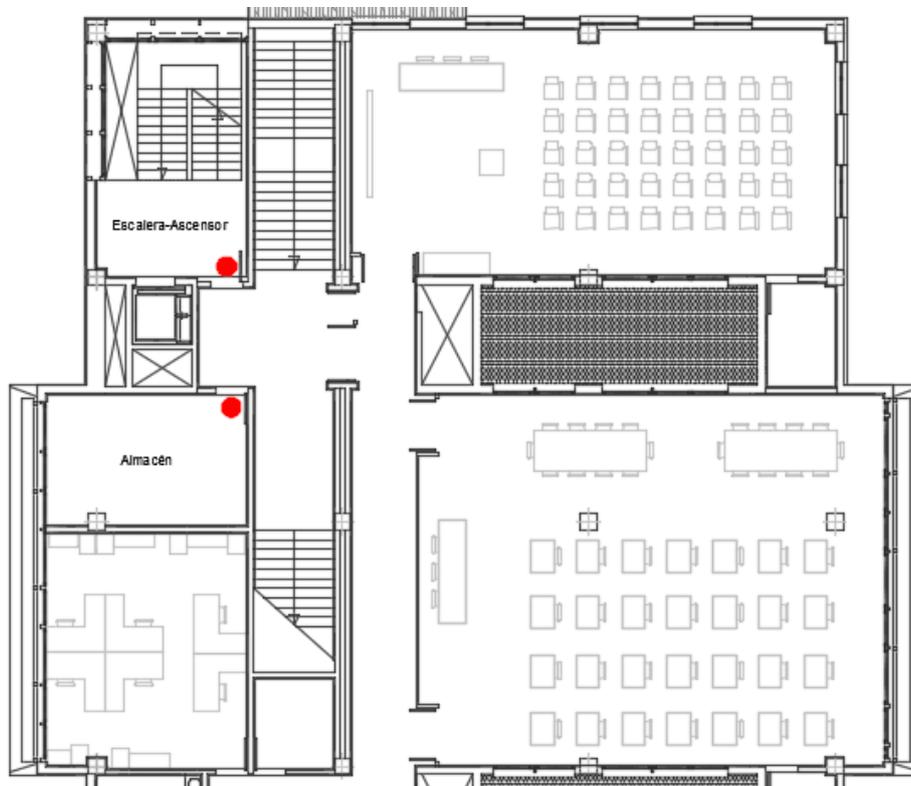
Cumplimiento Escalera Protegida Planta Primera. Figura extraída del plano 3.
